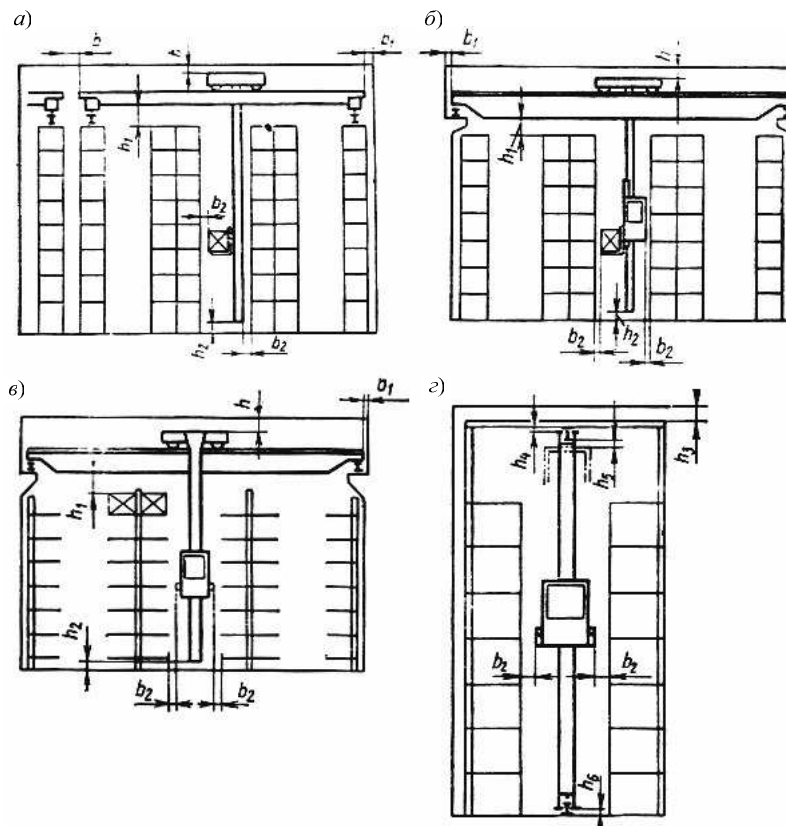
Расстояния между элементами конструкций помещений складов, стеллажами и кранами-штабелерами, обеспечивающие безопасную работу склада:
